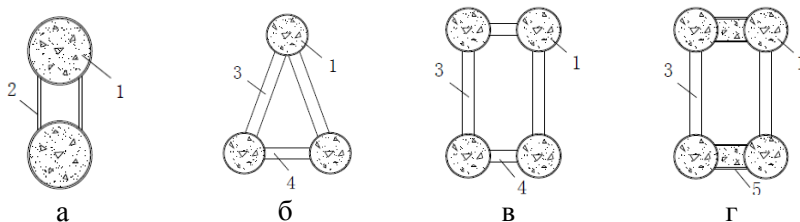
Типи поперечних перерізів трубобетонних арок:
